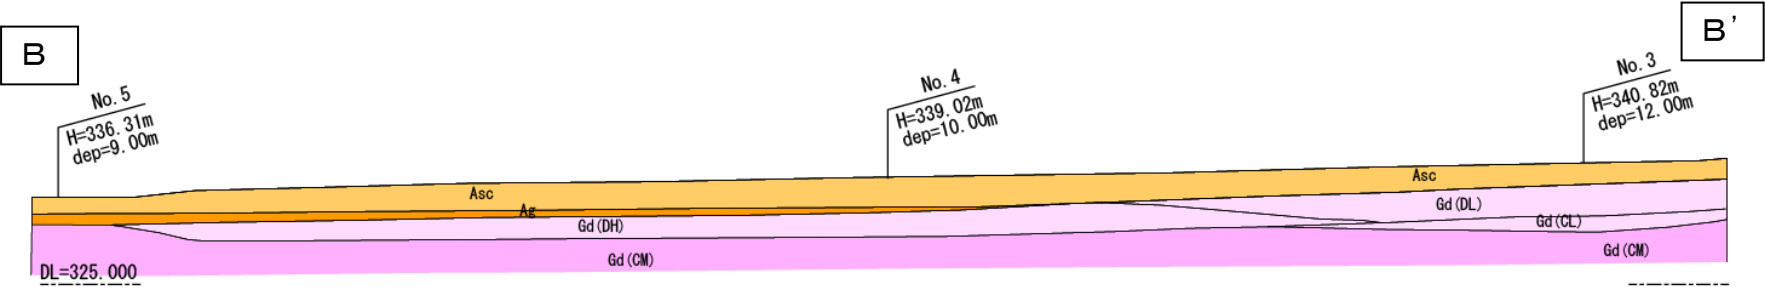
(2) 推定地質断面図 (B-B' 断面)
